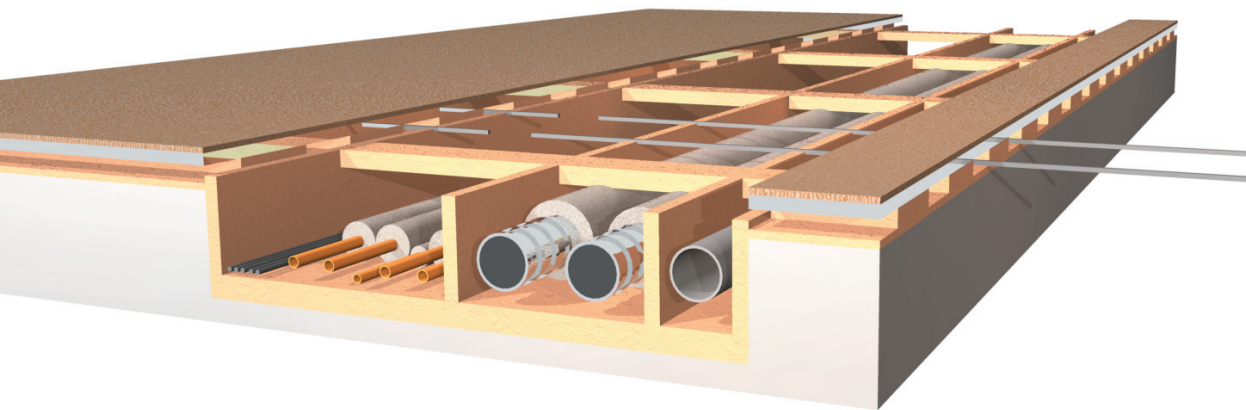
Geöffnetes Boden-Decken Element mit vorgefertigter Trassenführung und eingelegten Rohrleitungen
